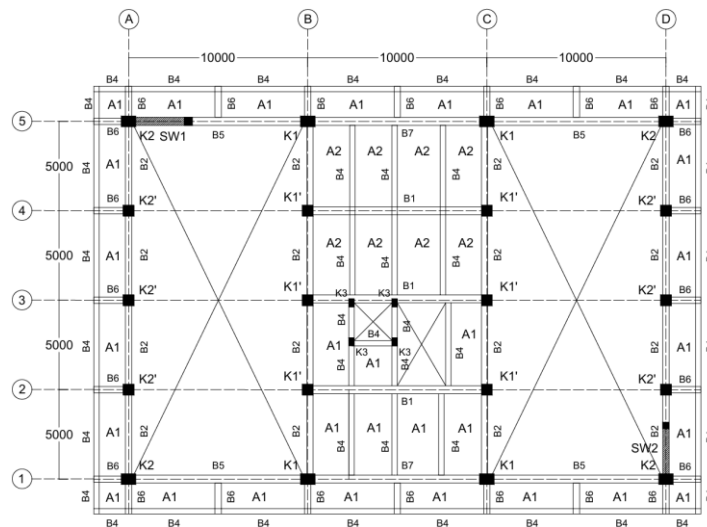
Denah lantai 4 gedung eksisting (model 1)
